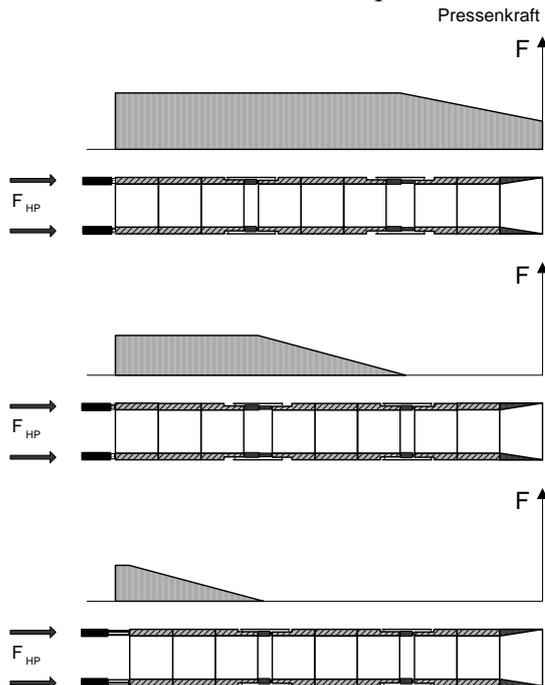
Pressenkräfte mit Zwischenpressstationen
